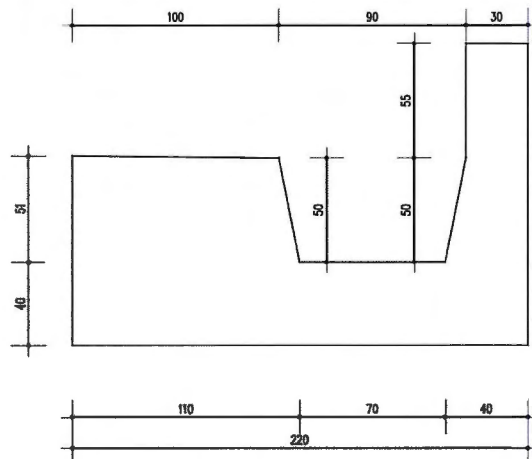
Sezione Tipo B (Senza Barriere) – Tratto 2
